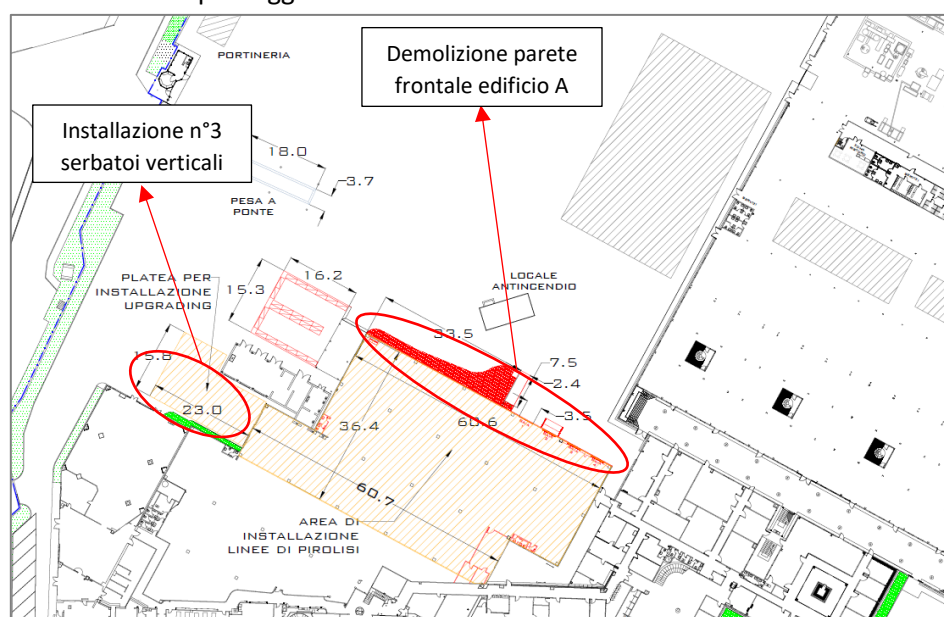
ESTRATTO TAVOLA T06_DEMOLIZIONI-COSTRUZIONI ALLEGATA AL FASCICOLO DI PROGETTO, INTERVENTI CERCHIATI IN ROSSO.
